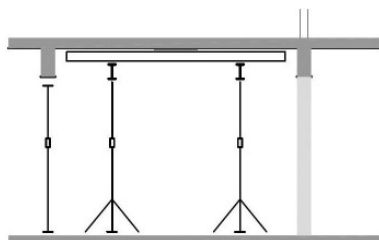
figura esquemática da retirada dos painéis laterais das vigas
